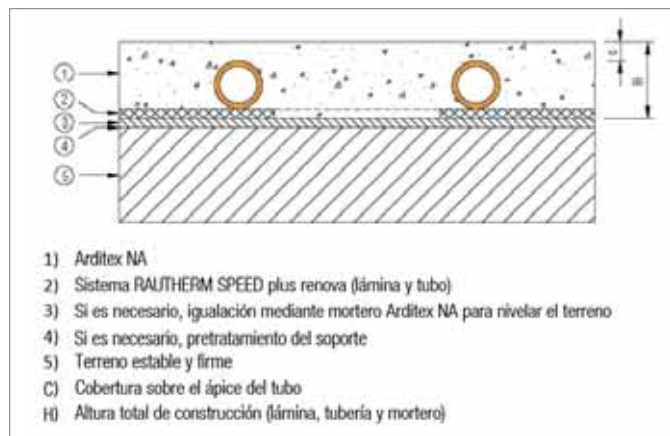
Vista en sección de RAUTHERM SPEED plus renova
